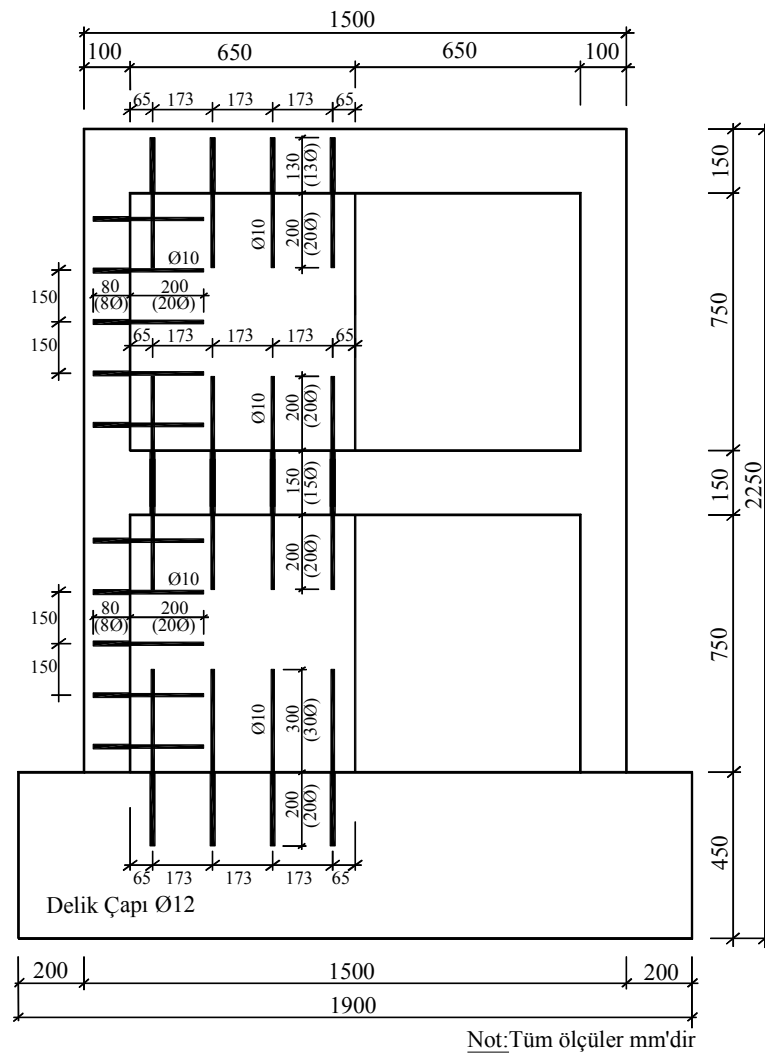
Deney Elemanı-4'ün donatı detayı
